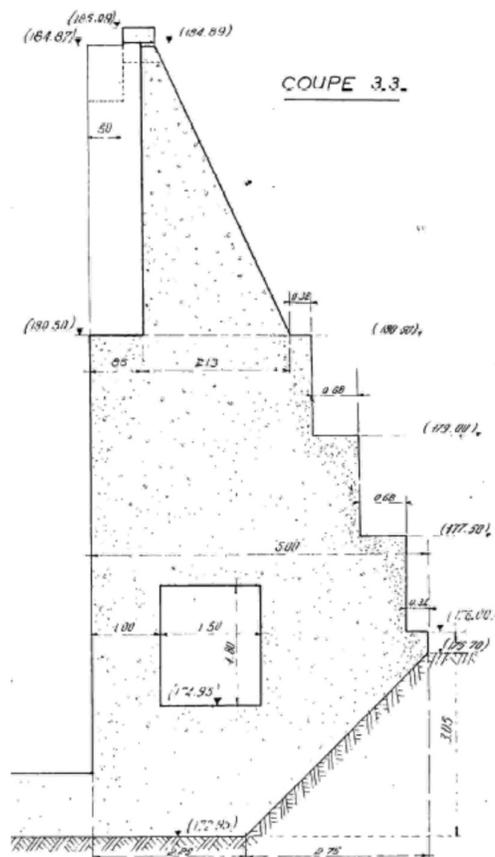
Coupe type du bajoyer rive droite au niveau du pont
